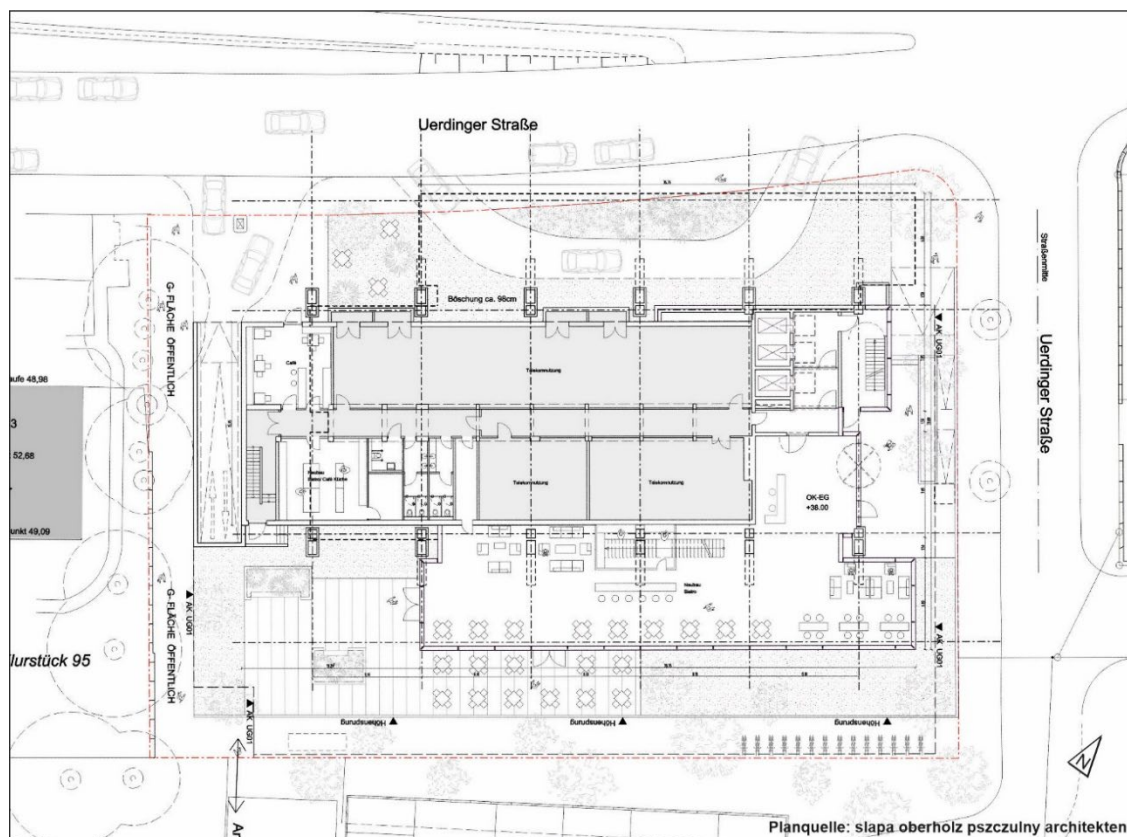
Lageplan/Grundriss Erdgeschoss der Planung
